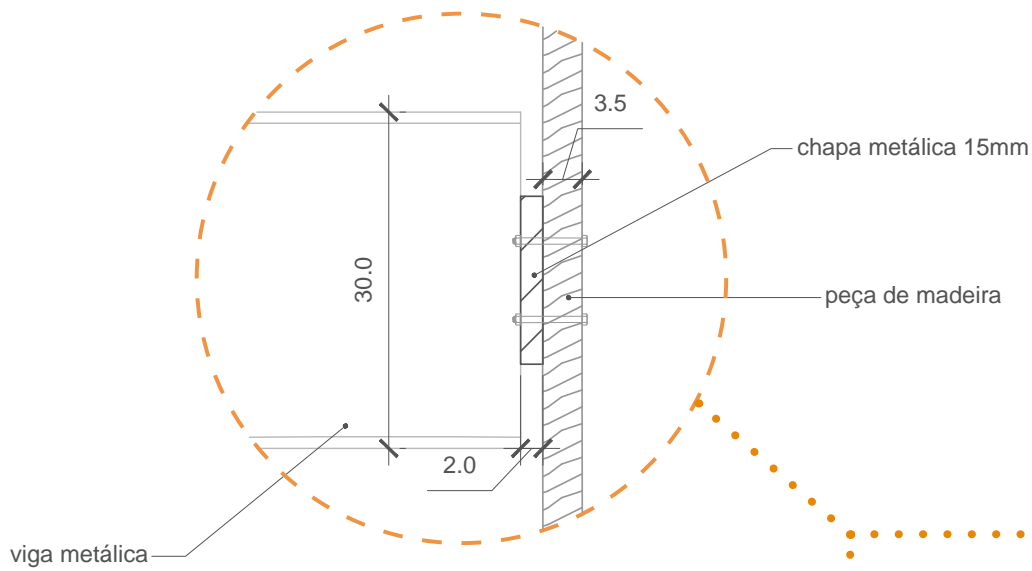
Detalhe construtivo de fixação dos brises de madeira, corte lateral.
